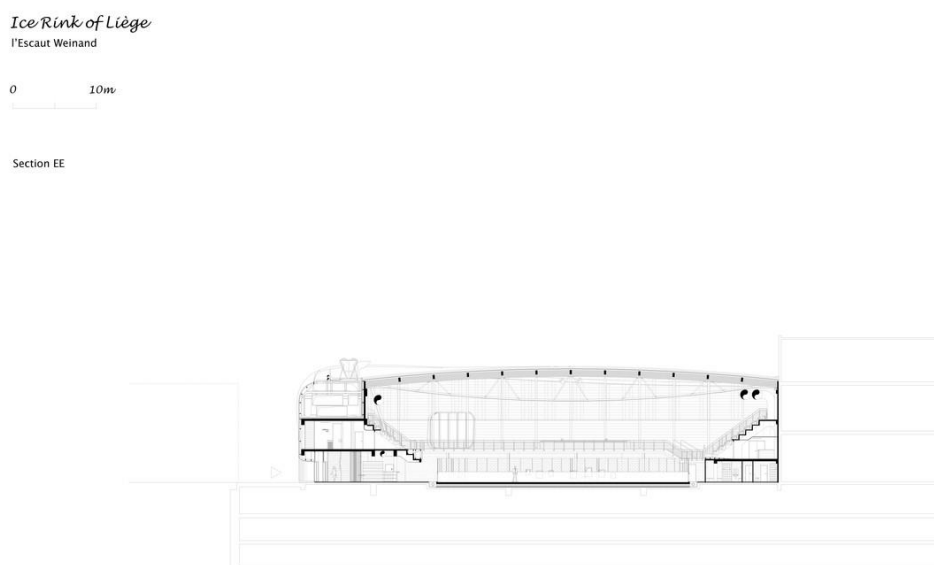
Поперечний розріз, арх. L'Escaut Architectures + BE Weinand [5]
